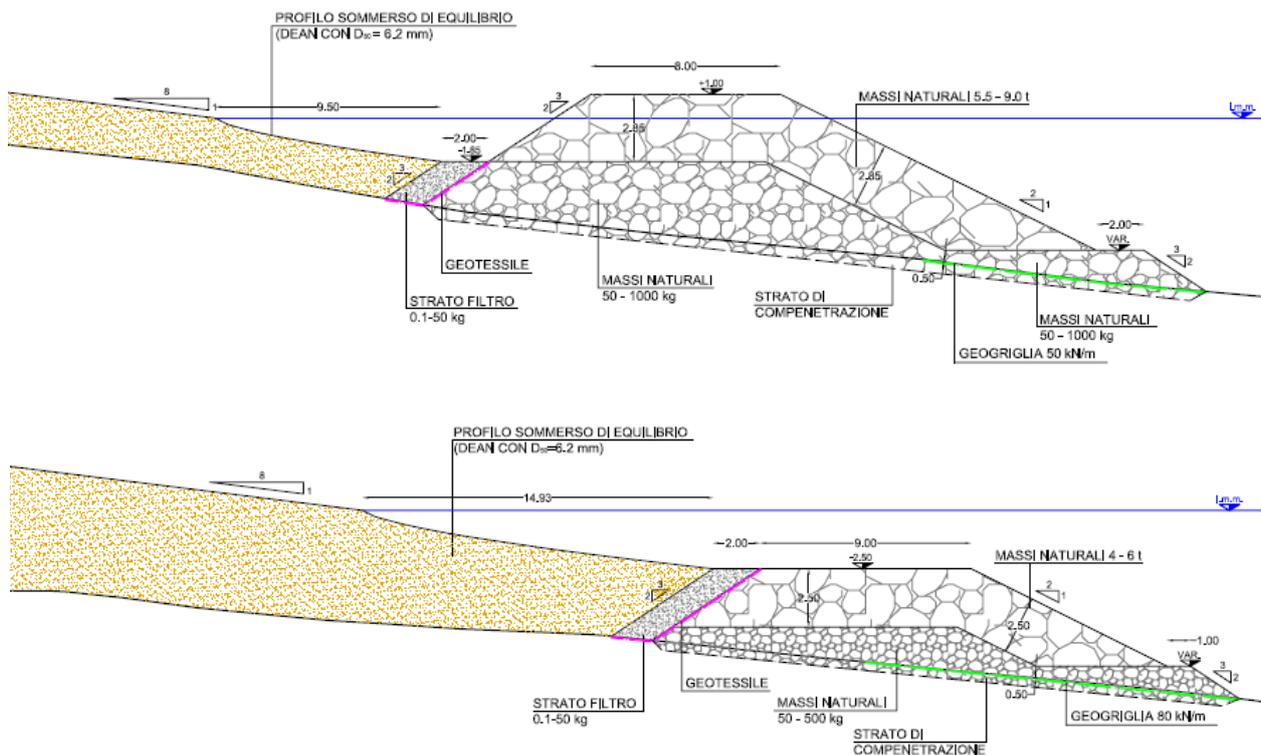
Sezioni tipo delle scogliere del ripascimento protetto
